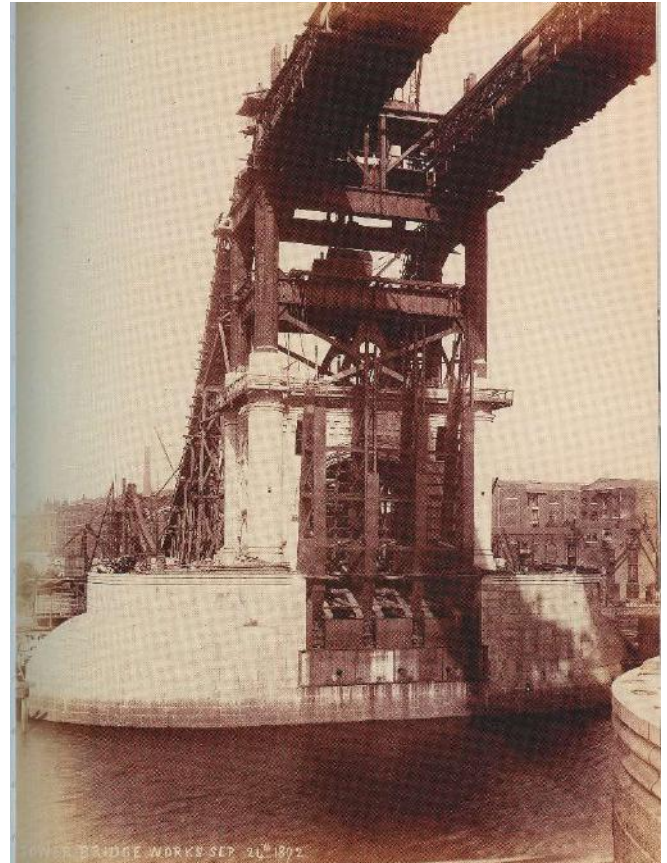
Fundament eines Turms, mit Wellenbrecher und Kellerraum zum Einschwenken der Hebebrücke.
